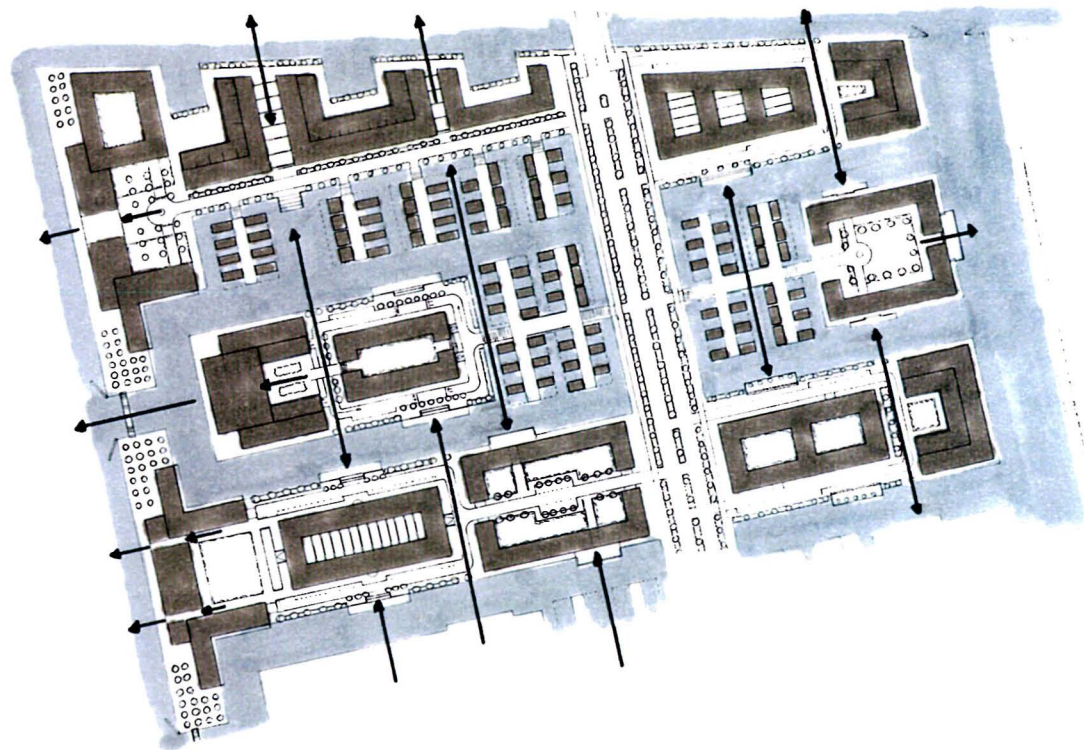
belangrijke zichtlijnen op en tussen de pieren
